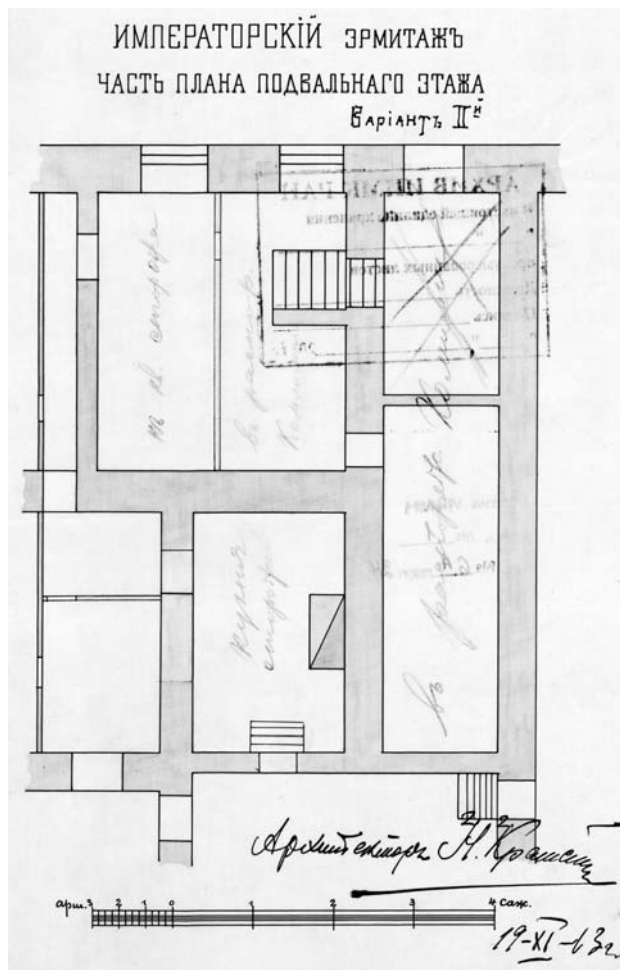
План подвального этажа Эрмитажа, 1913 г.
